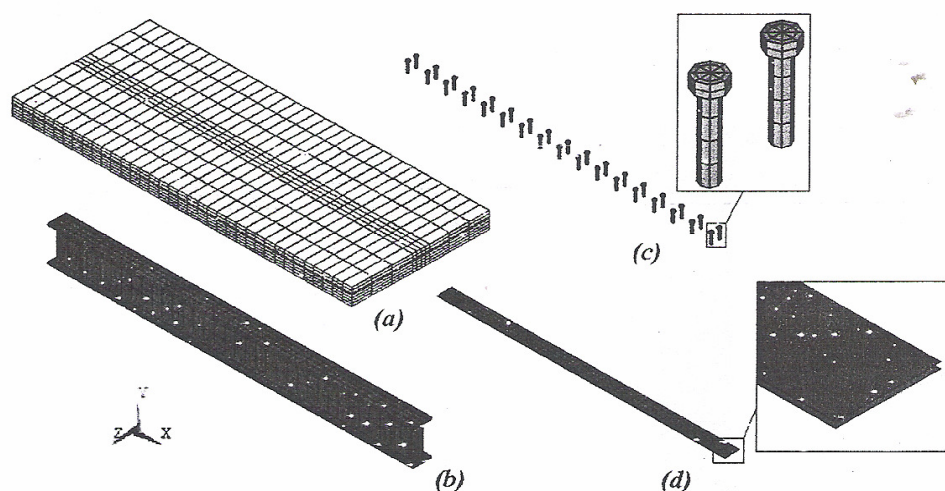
Grupos de elementos finitos: (a) laje de concreto, (b) perfil de aço, (c) conectores de cisalhamento e (d) par de contatos entre a laje e a viga [15]
